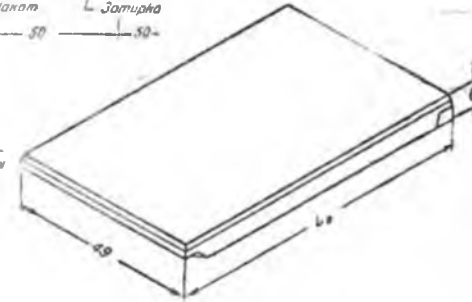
Перекрытие с несущим накатом и гладким потолком по железобетонным балкам
